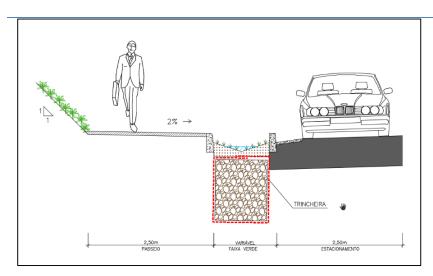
Locação da Trincheira abaixo da faixa verde.
